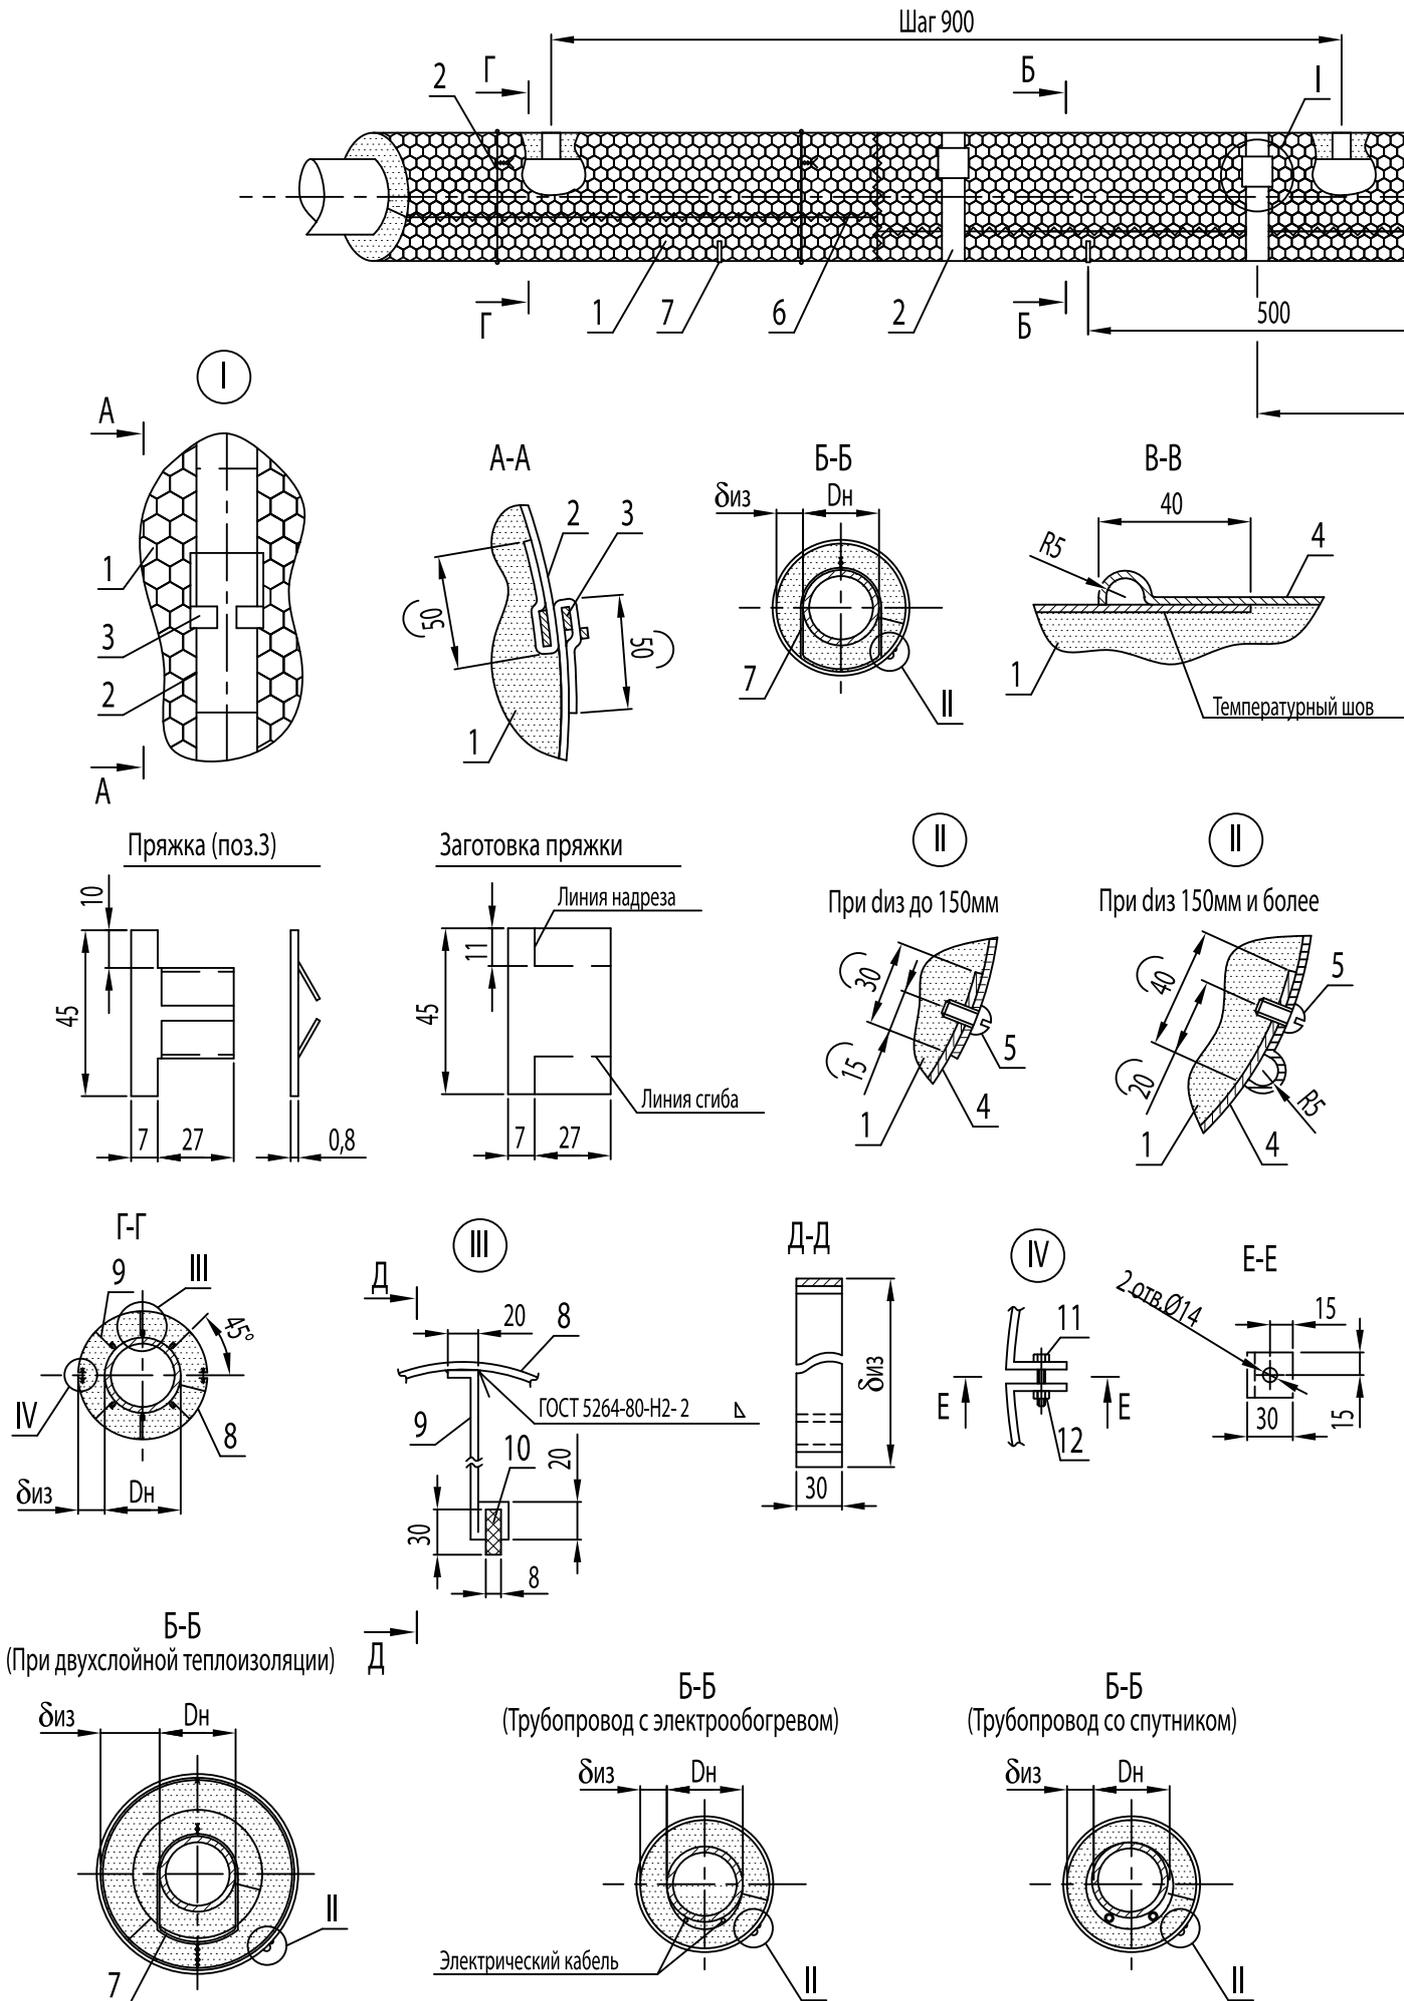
Схема тепловой изоляции элементов трубопровода
